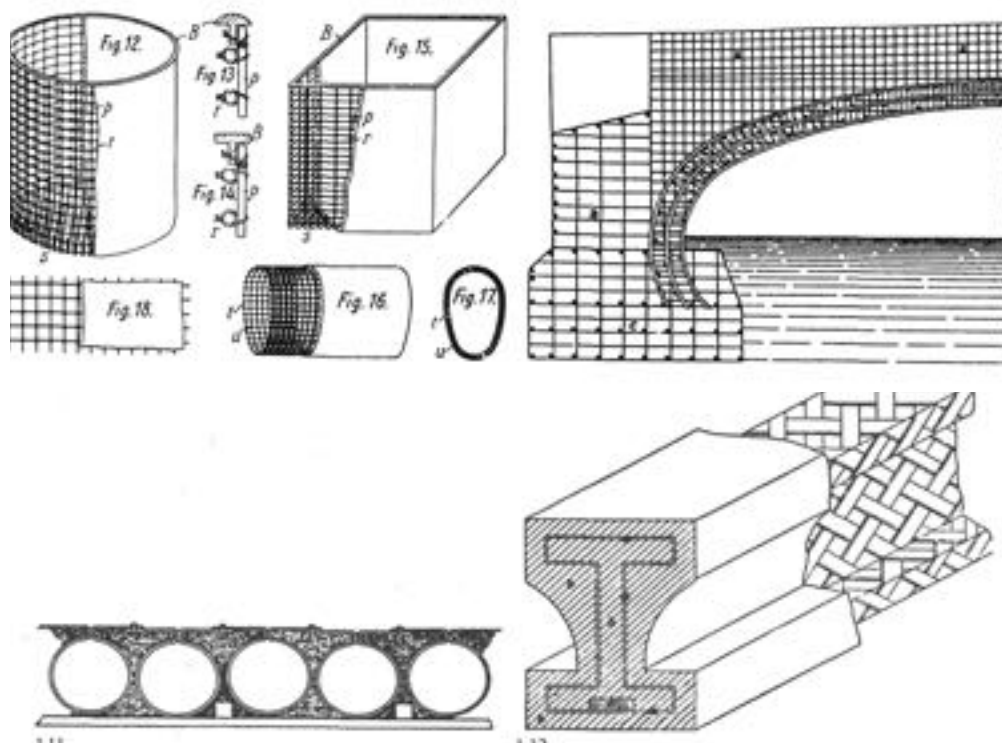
| In alto: Joseph Monier, disegni dal suo brevetto tedesco, 1871; disegno dal suo brevetto per la costruzione di ponti, 1873. In basso: Thaddeus Hyatt, disegno dal suo primo brevetto per il calcestruzzo armato, 1871 e di un secondo brevetto del 1874.
